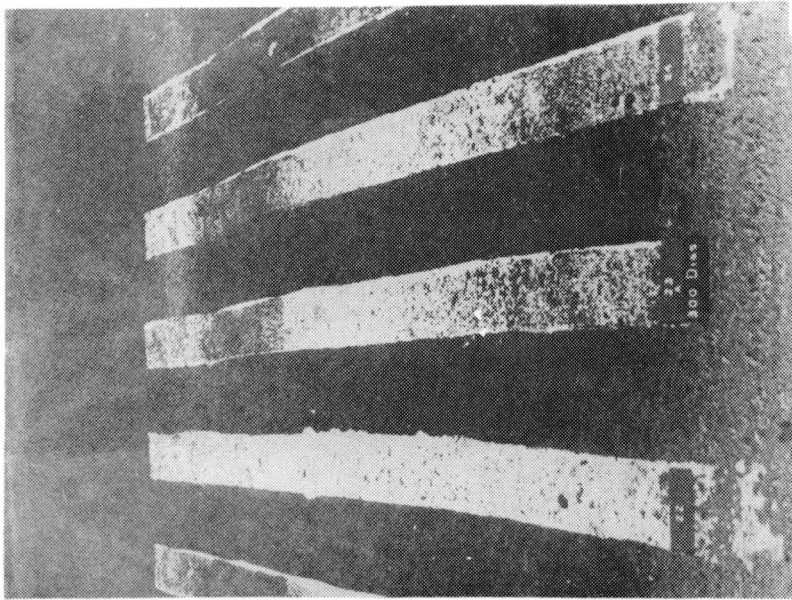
Muestras 22, 23 y 24, 300 días sobre pavimento asfáltico
